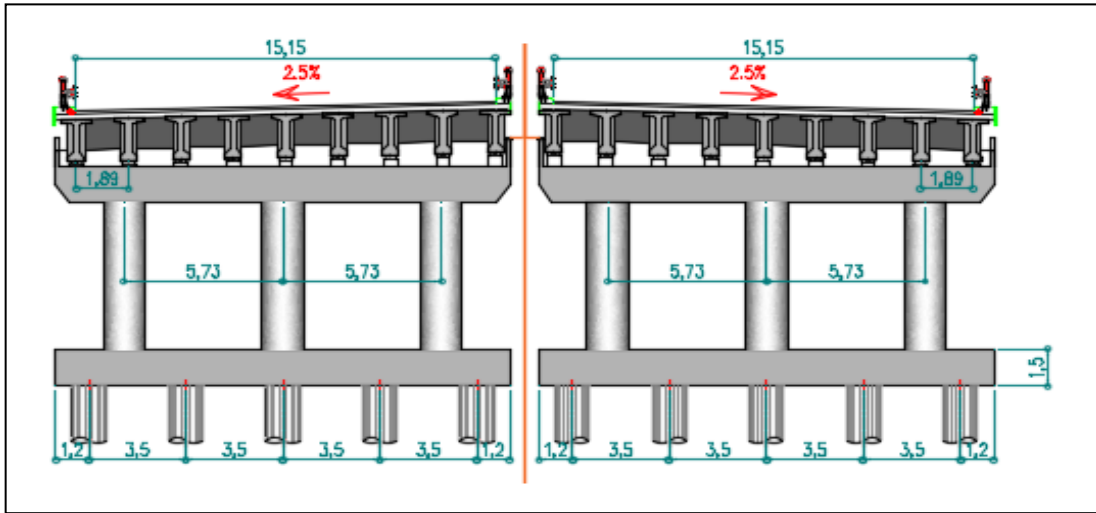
Coupe transversale sur pile VARIANTE 01
